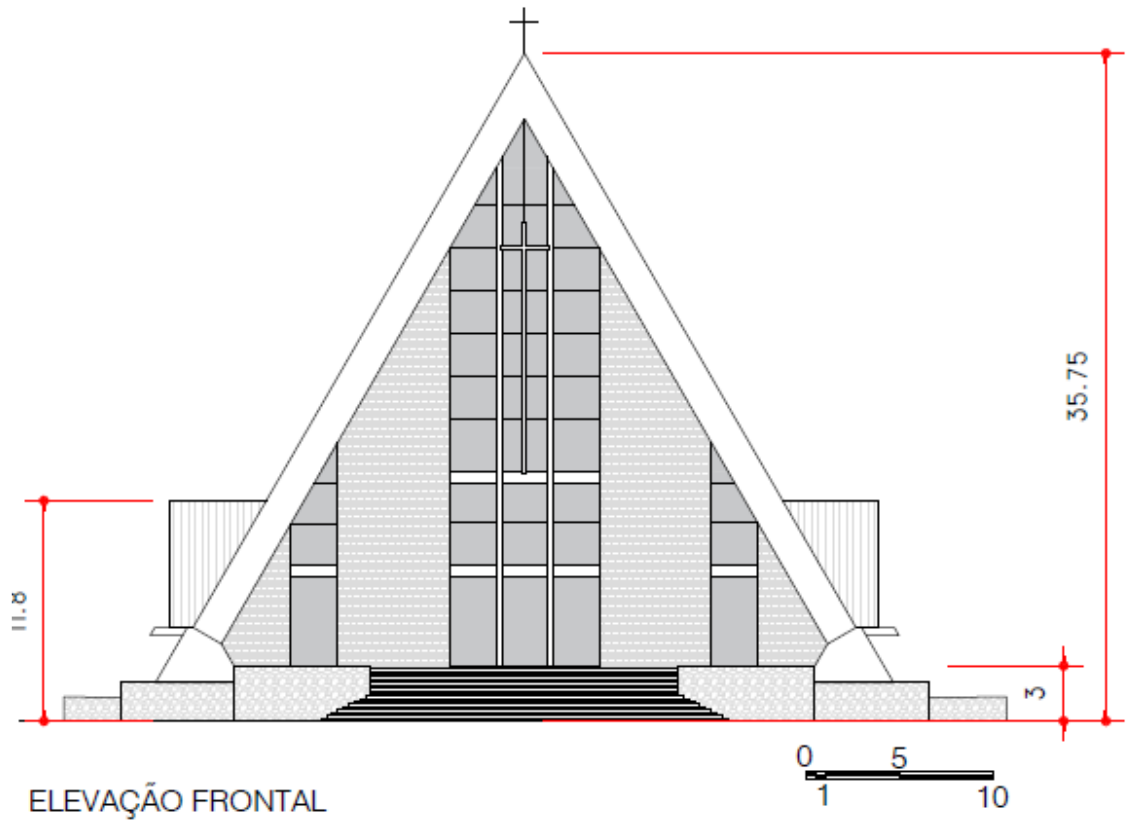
Planta Catedral Metropolitana de Londrina. 1966.
